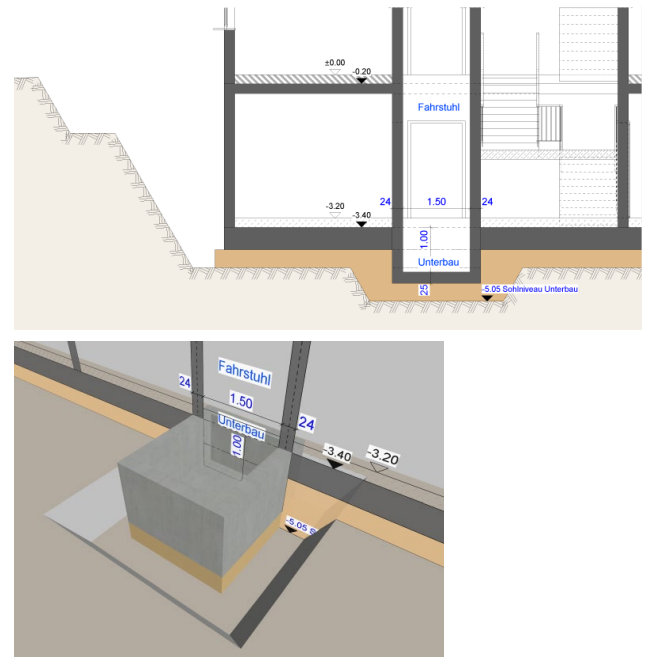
Mehrere Baugruben (Baugrube Unterbau Fahrstuhl)
